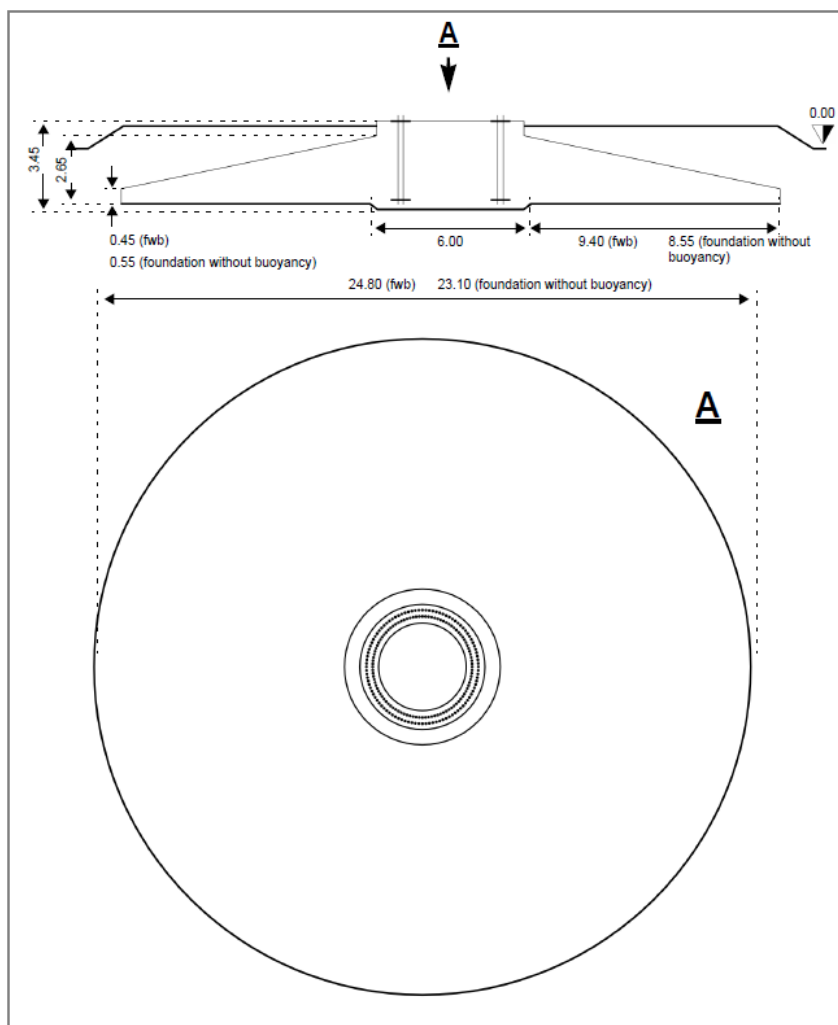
Planimetria e sezione “tipo” del basamento dell’aerogeneratore NORDEX N163
